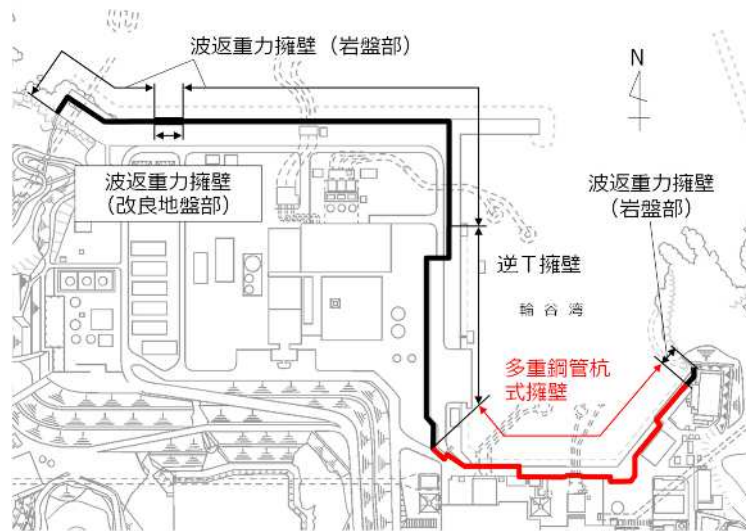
防波壁（多重鋼管杭式擁壁）の平面配置図
